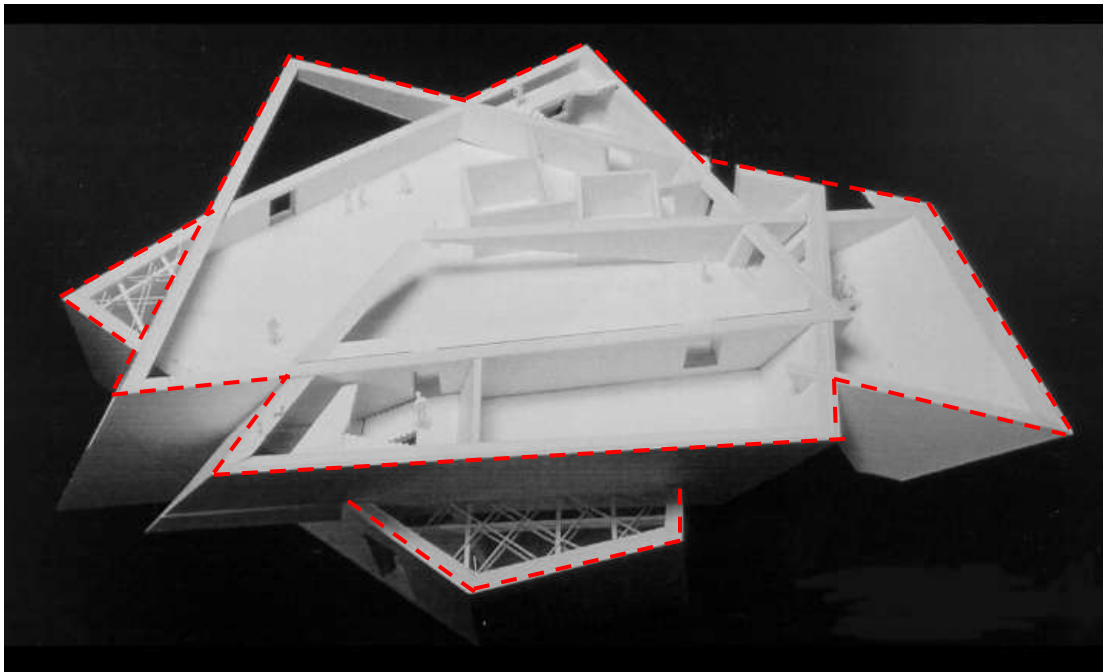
Maqueta mostrando los posibles cambios múltiples con que se construye la planta. Fuente imagen.<sup>162</sup>
